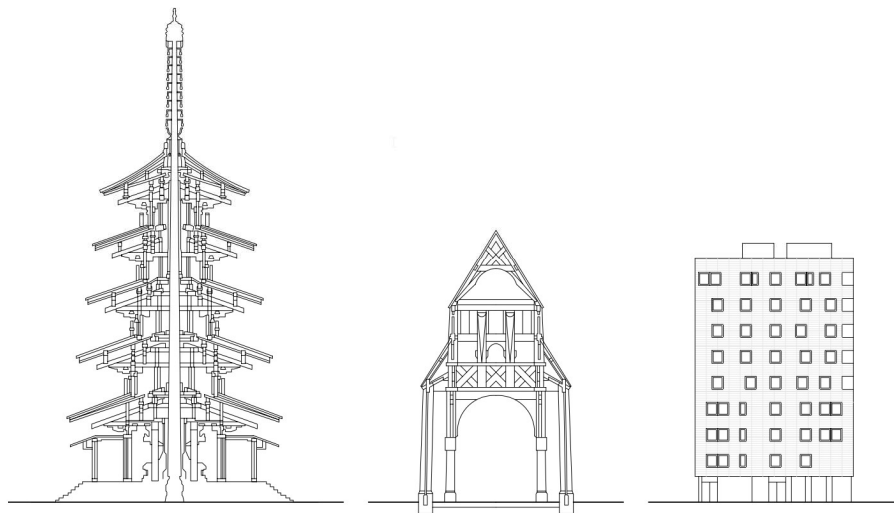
Trois structures bois de grande hauteur à travers l'histoire (Tiré de [Green, 2017]). (Gauche) Temple Hōryū-ji à Nara au Japon construit en 607 ; (Milieu) Eglise Urnes stavkirke en Norvège construit en 1130 ; (Droite) Bâtiment bois Stadhaus, Murray Grove à Londres construit en 2008. (Dessins à l'échelle)
